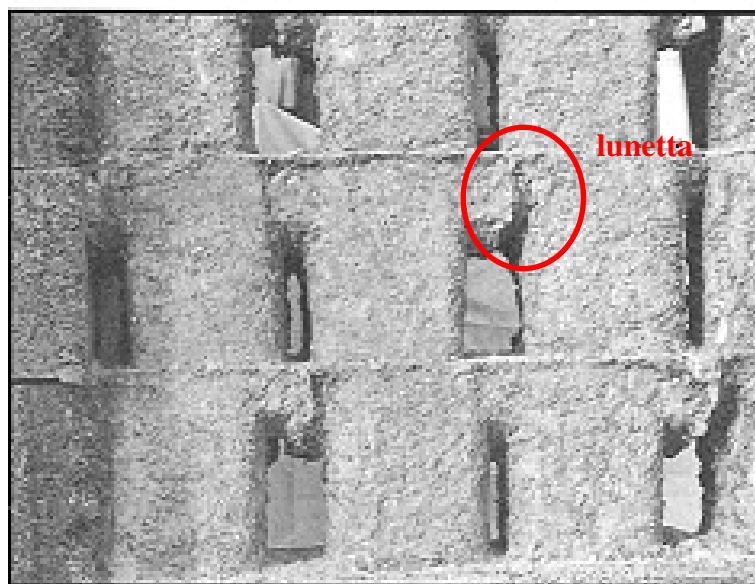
Sezione interna del setto di calcestruzzo epurato dai casseri
